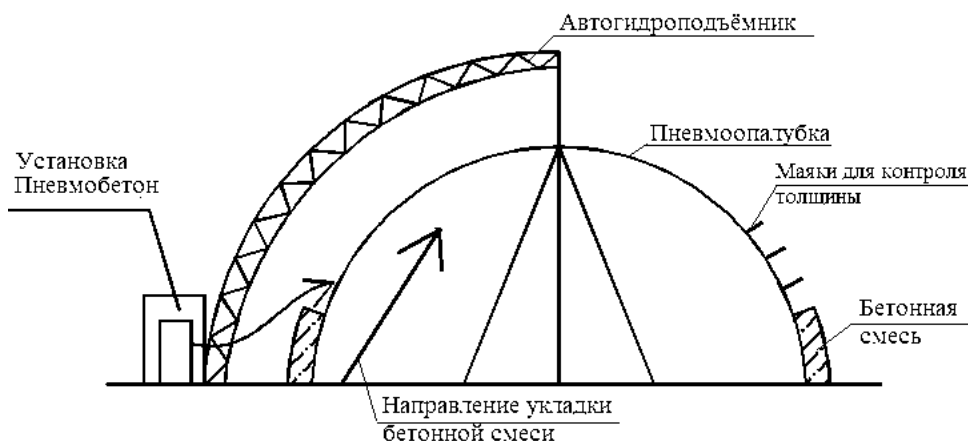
Схема нанесения бетонной смеси на пневмоопалубку
